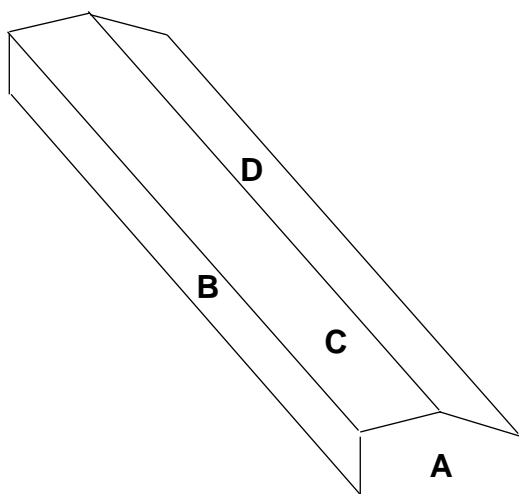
Muros y cubiertas de fábrica 1. Elaboración propia.
